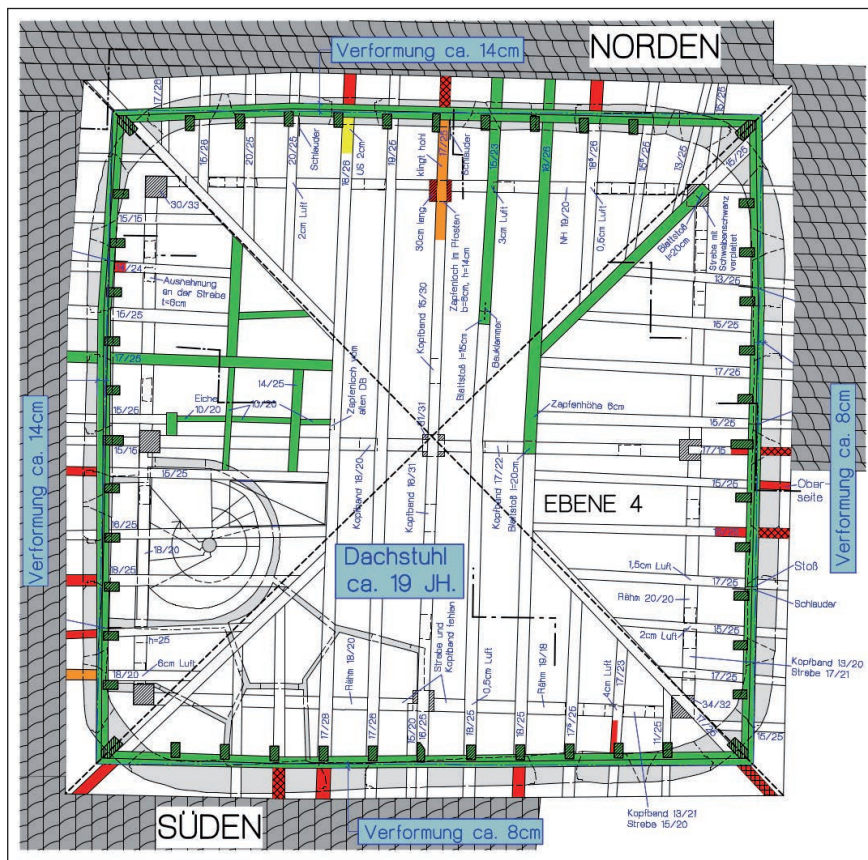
Grundriss der Ankerbalkenlage des Bergfrieds – Schadenskartierung.
